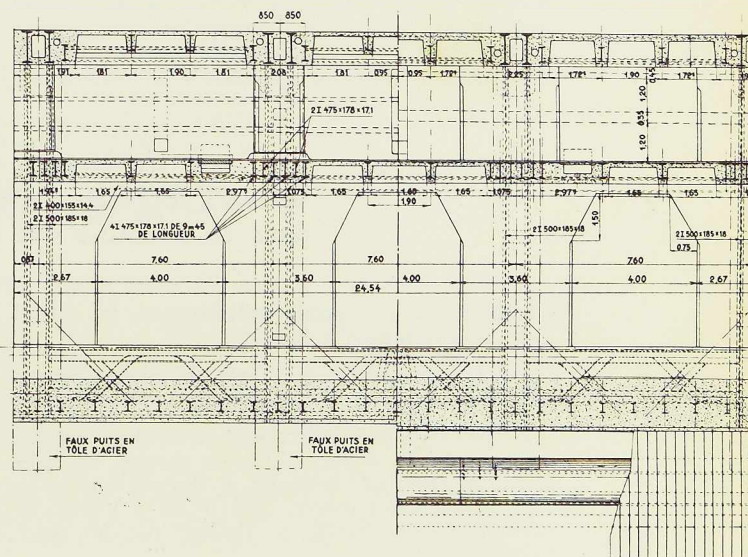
Coupe longitudinale du tunnel de la Jonction Nord-Midi, à Bruxelles.
